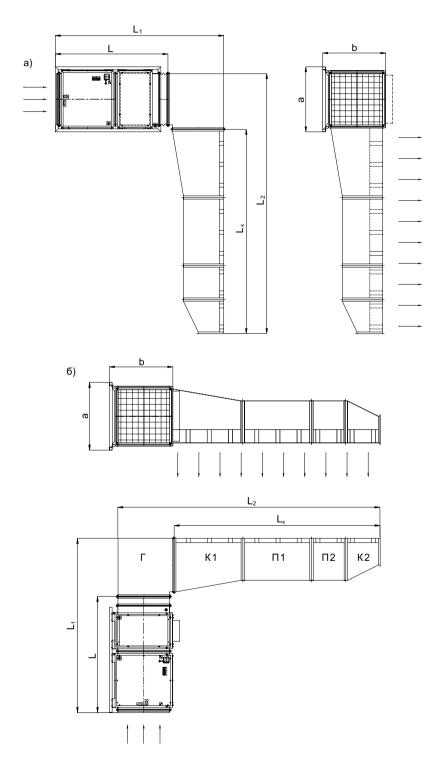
Габаритные размеры стандартных завес с «Г-образным» силовым блоком: а) — вертикального расположения; б) — горизонтального расположения
